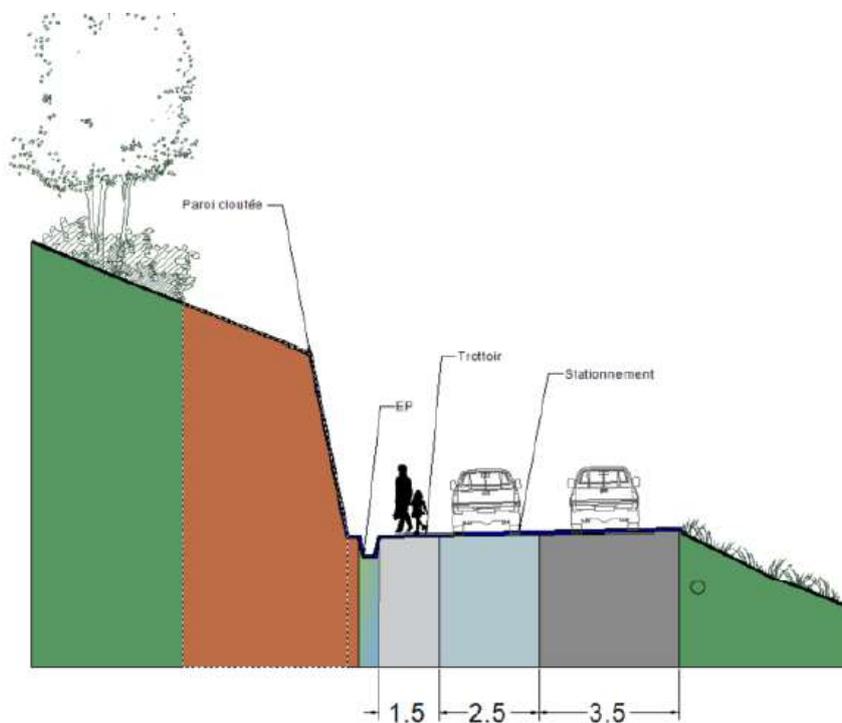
Profil en travers rue des coteaux sur l'intercepteur
